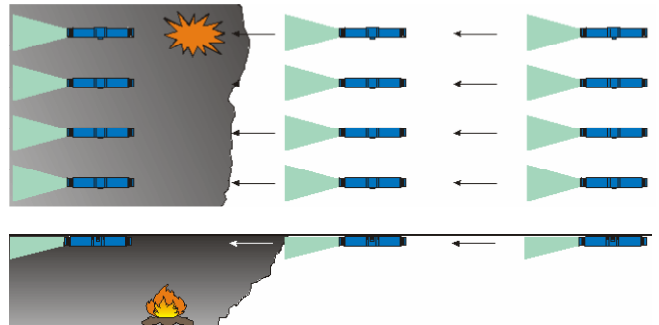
Schematische Darstellung der Rauchausbreitung mit dem Jet-Ventilationssystem
